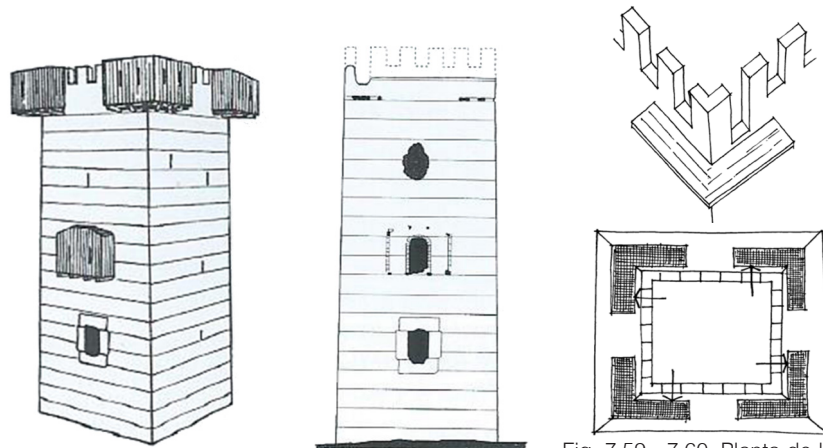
7.58. Reconstrucción hipotética del aspecto original. Alzado de la torre en su estado actual y con la reconstrucción del almenado. (Según Cantos Carnicer)
